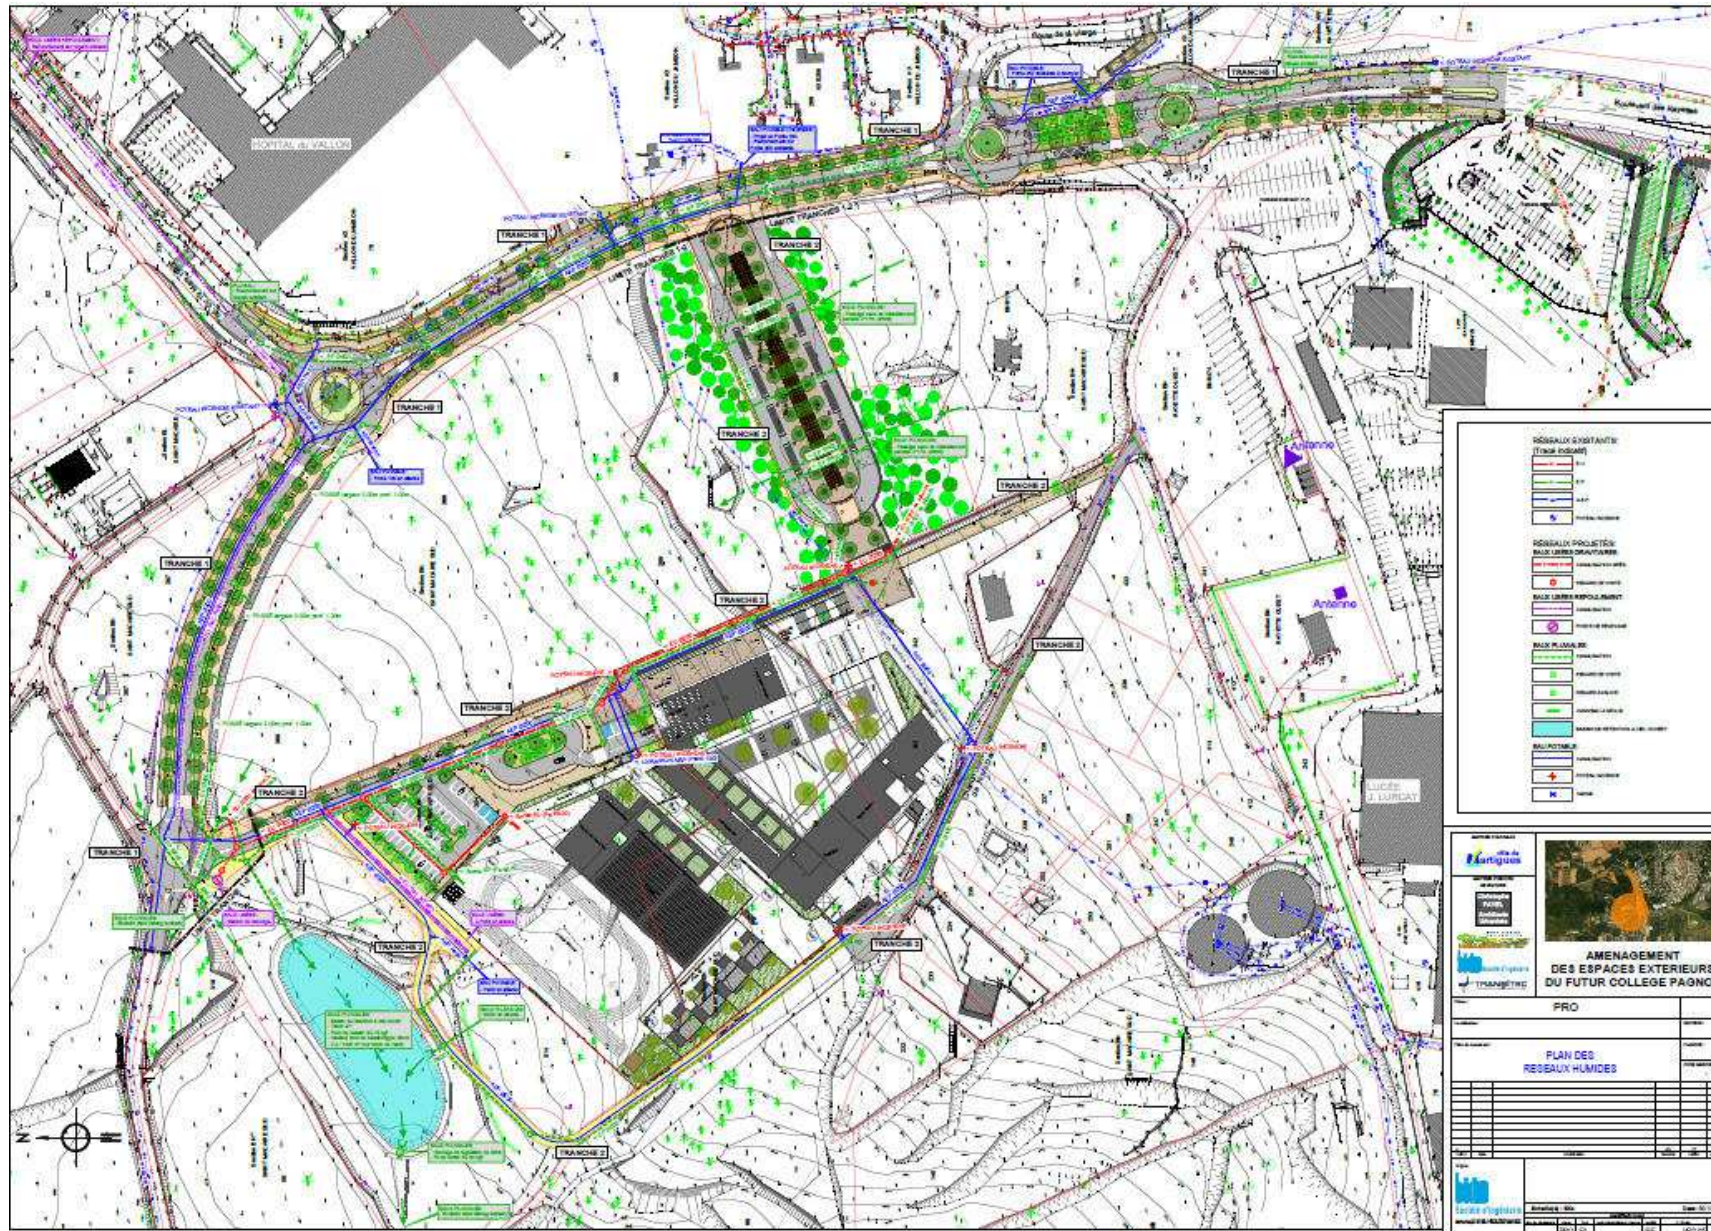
Plan des réseaux aux abords du futur collège (source : BERIM)
